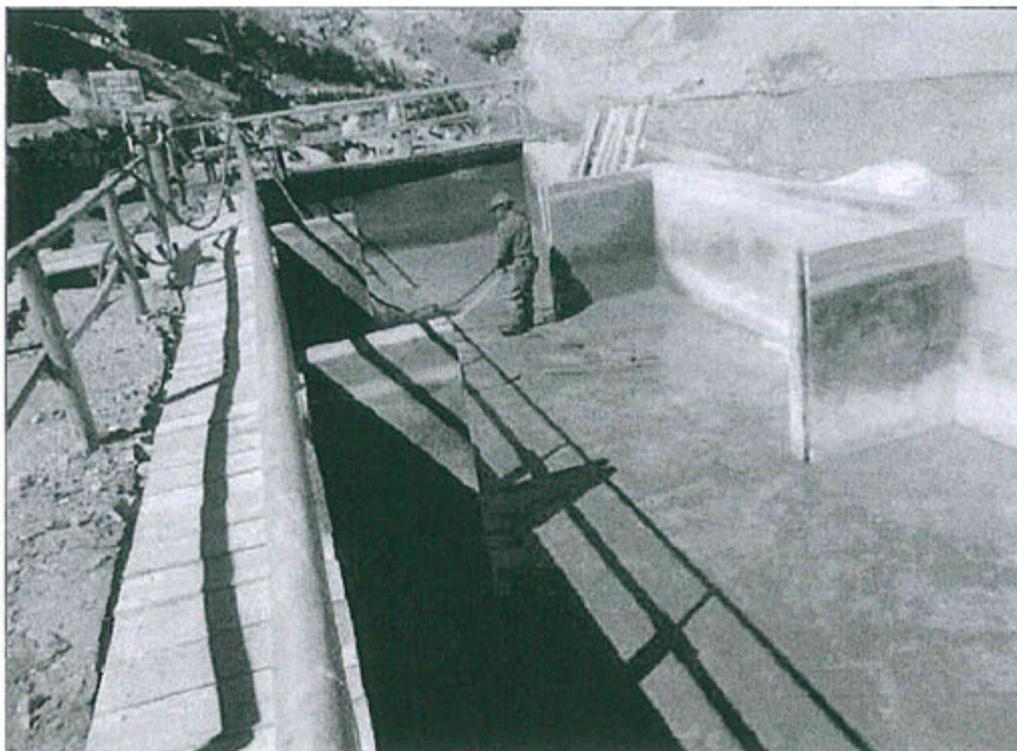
Vista de la Planta de tratamiento de agua de minas
